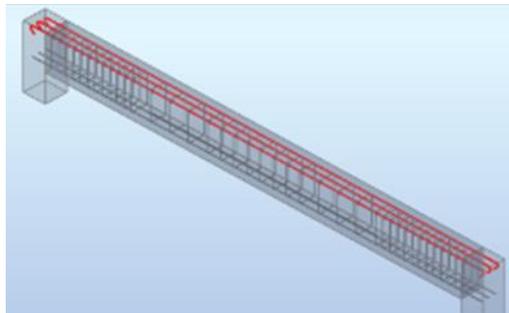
Exemplo de modelo tridimensional de armaduras em vigas.
